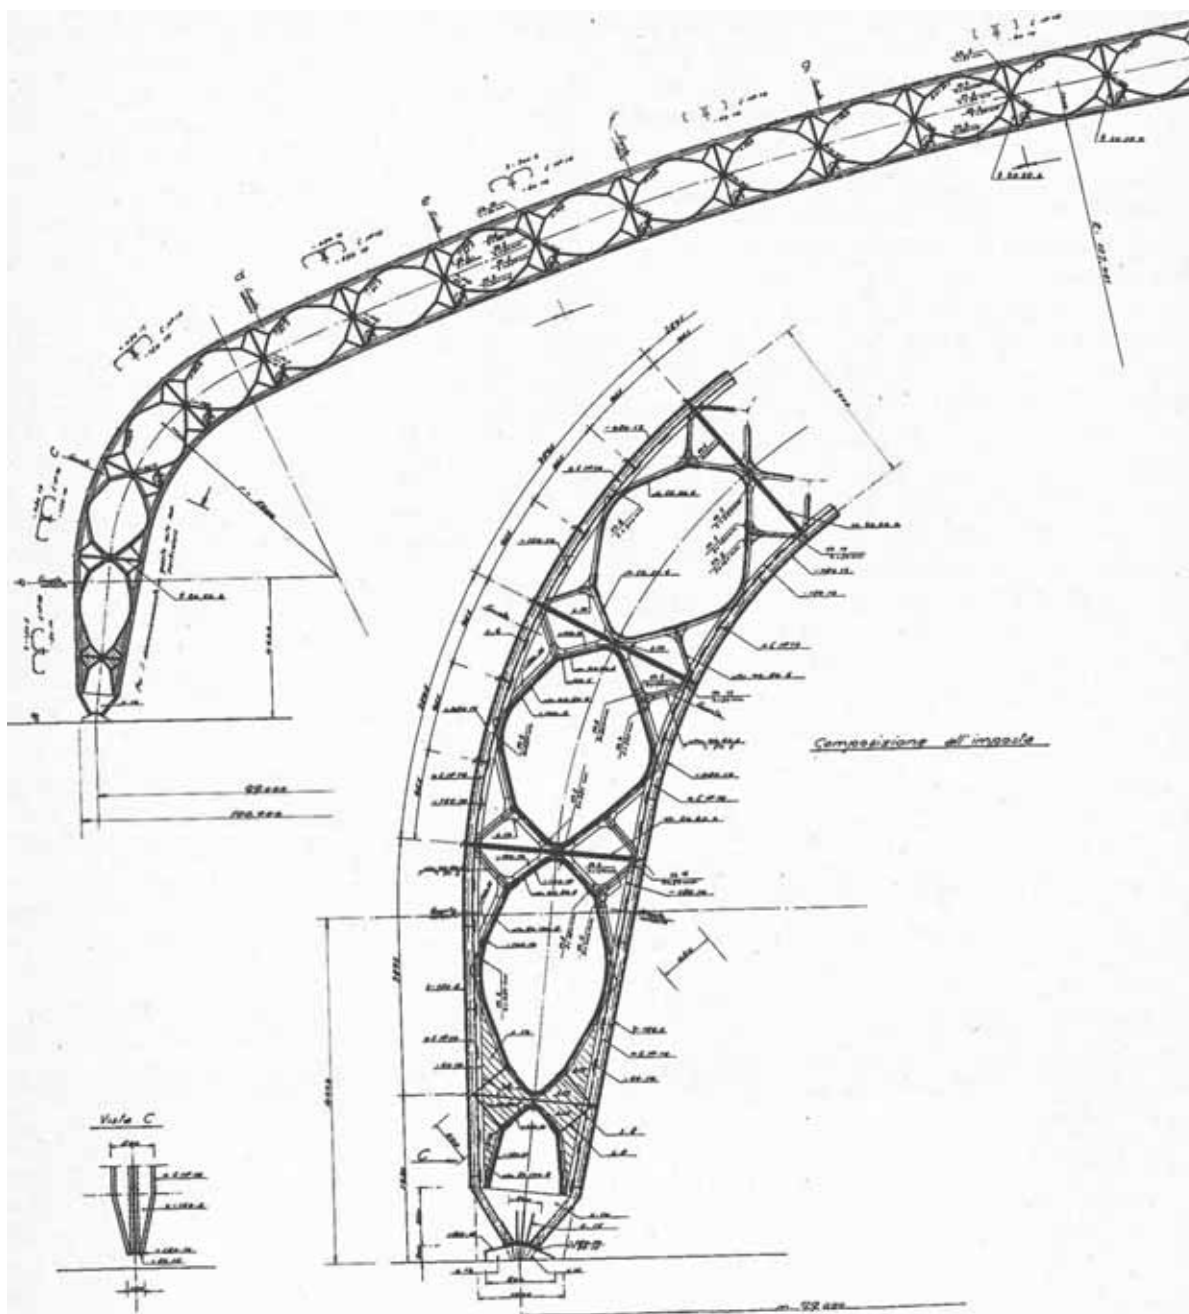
Copertura del padiglione meccanica della Fiera di Milano, CM n. 3/51
